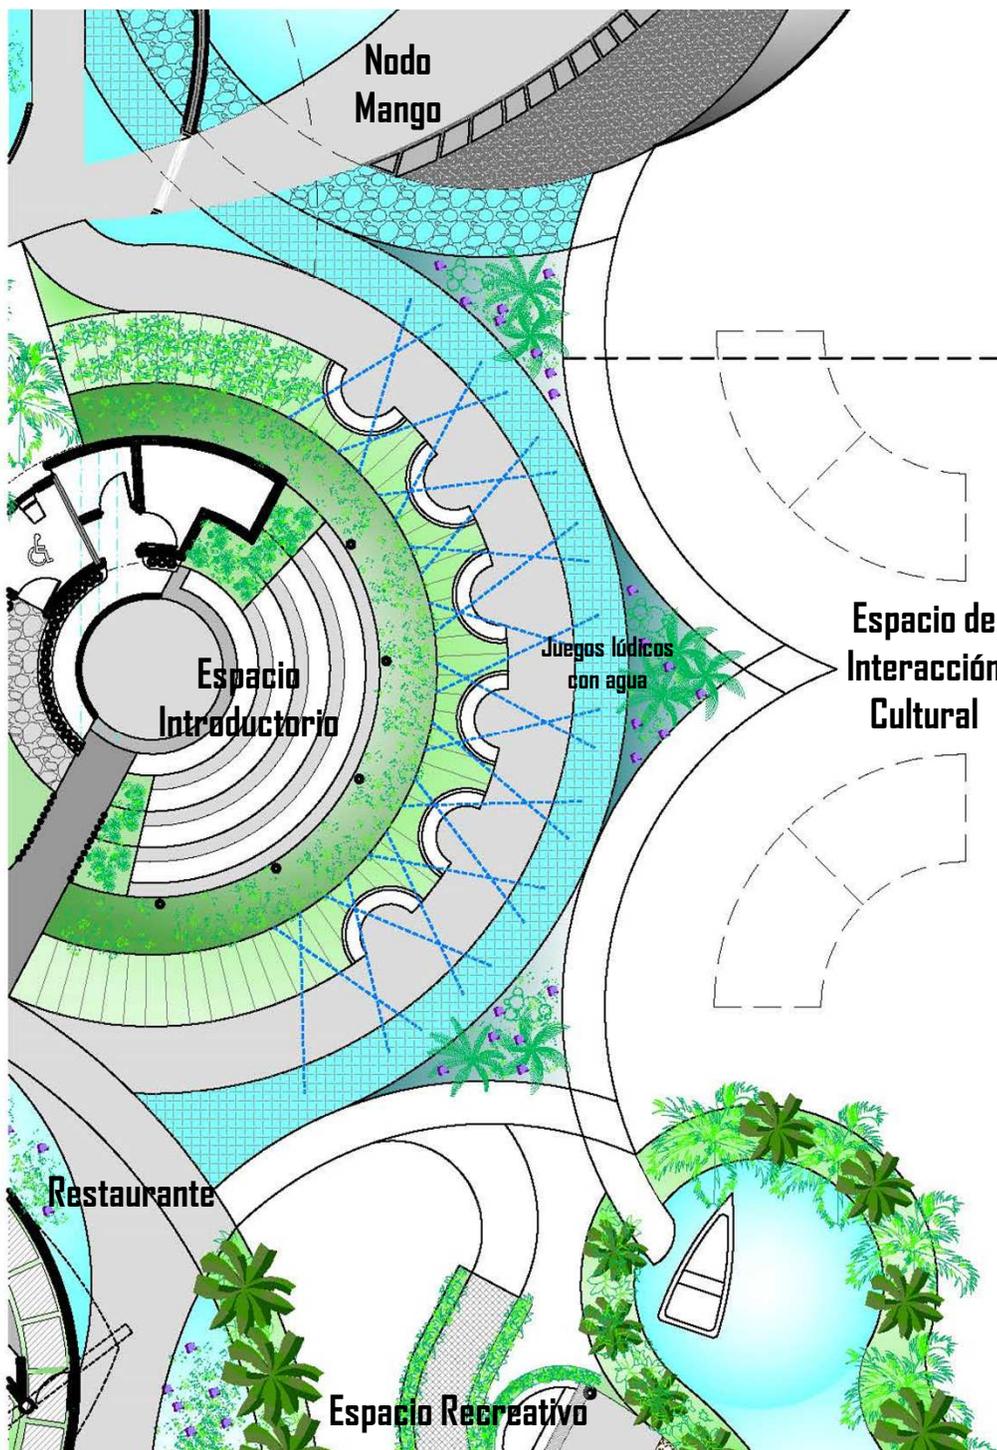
Planta de distribución arquitectónica Centro de Interacción Cultural
